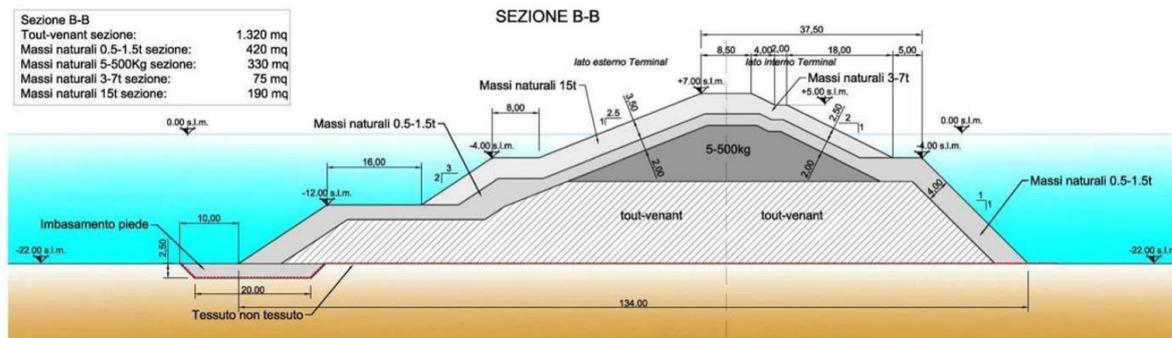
Dettaglio Sezione BB Diga Foranea
